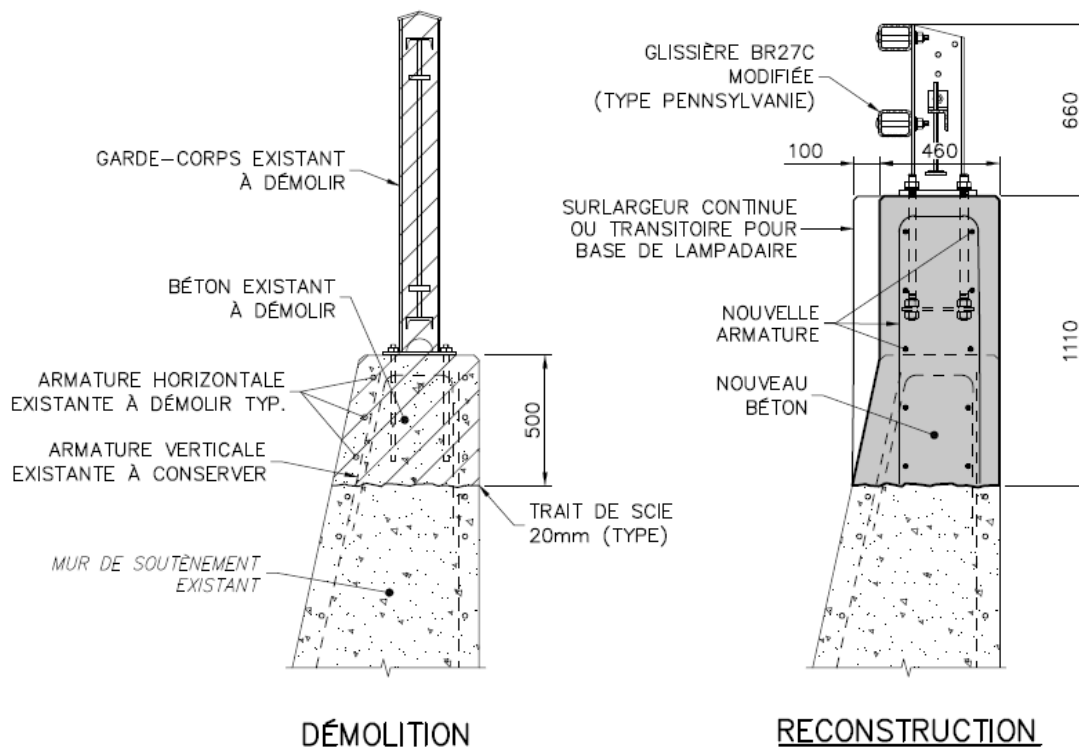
Mur de soutènement – Dispositif de retenue – Dispositif de retenue de type BR27C
